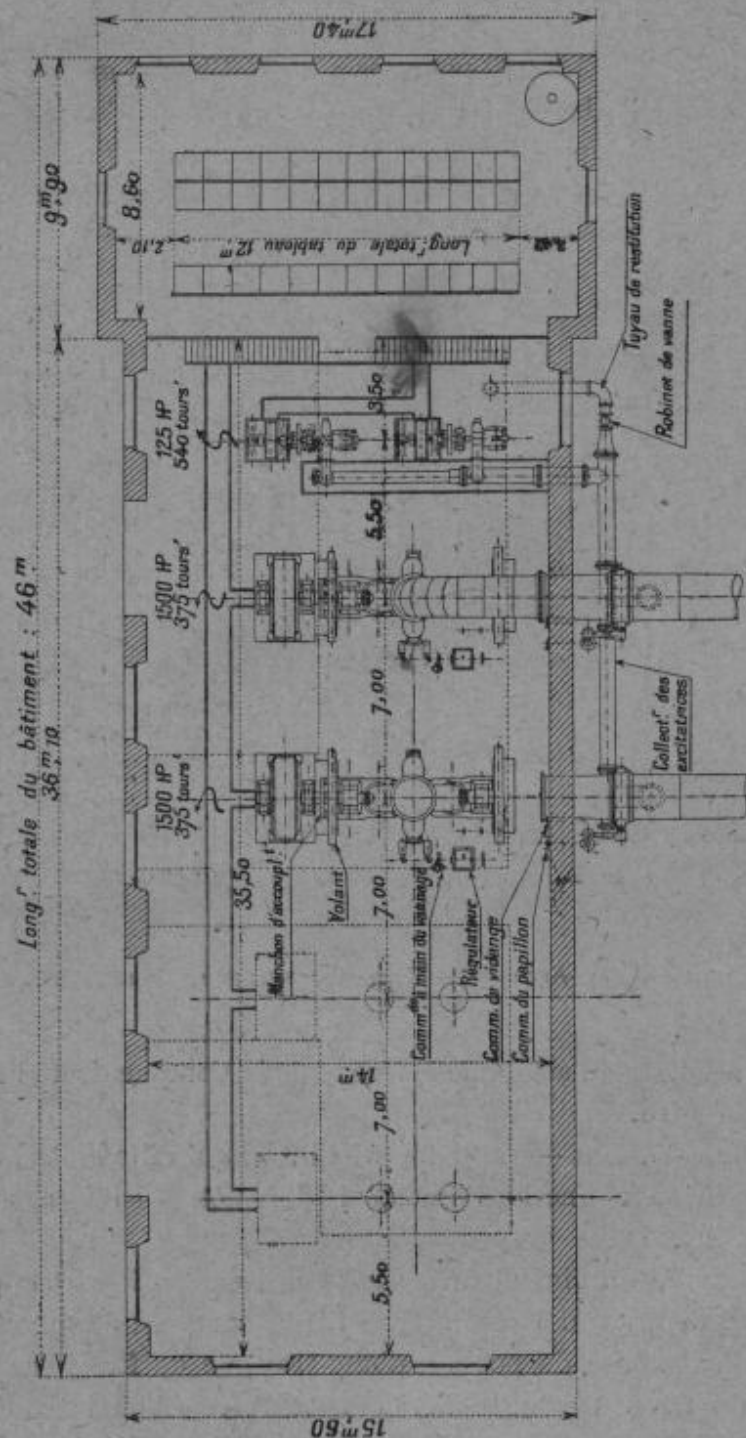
Usine de Teillet-Argenty. — Salle des machines.
